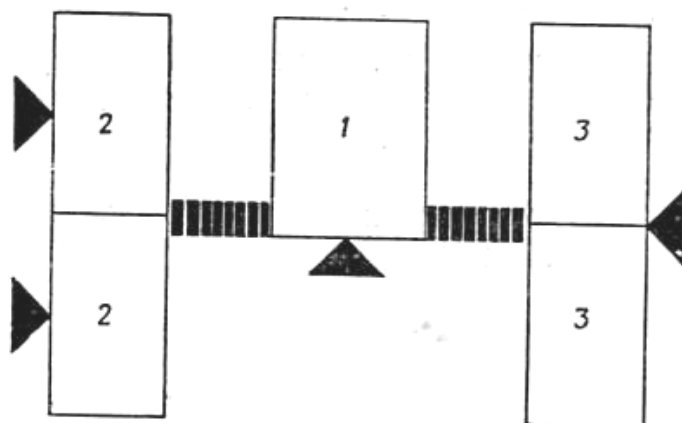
Схема группировки помещений в детских дошкольных учреждениях (детских яслях – садах).
